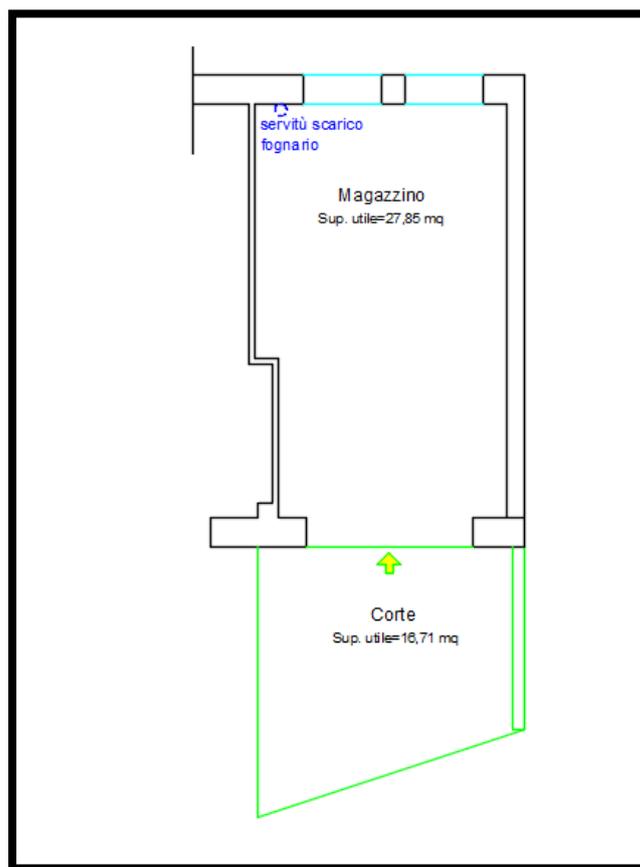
Rilievo appartamento part. 683 sub 4 – Piano seminterrato
